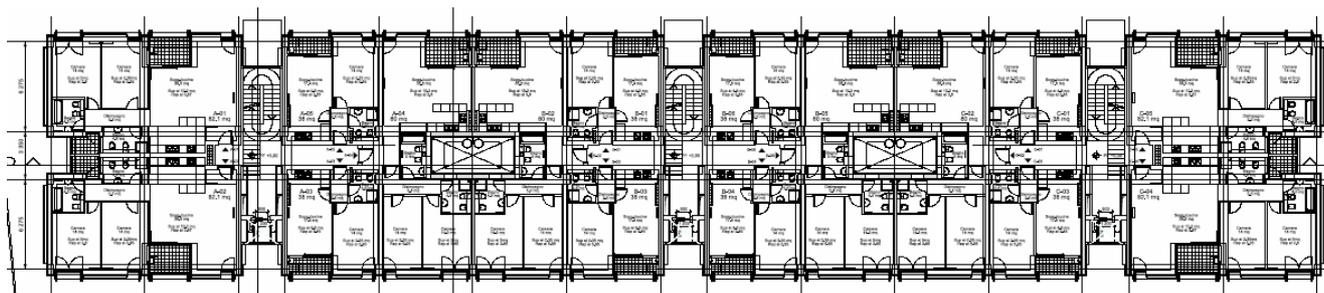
Piano dal 1 al 5 dell'Edificio R
